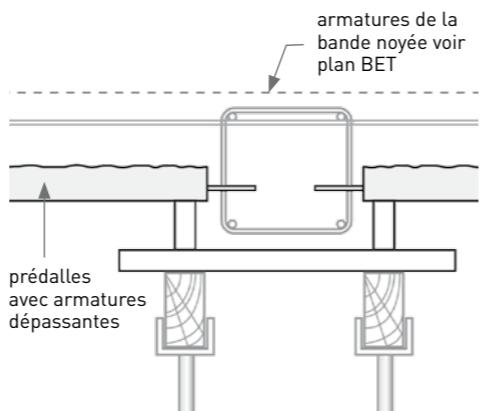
PRÉDALLES SUR BANDE NOYÉE OU SUR POUTRES VOILES AVEC RETOMBÉES
